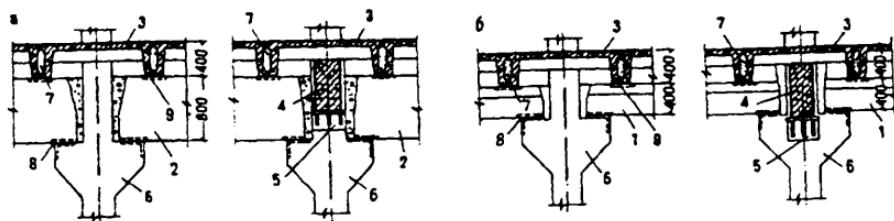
Опирание плит перекрытия на ригели в зданиях с верхним крановым этажом:
